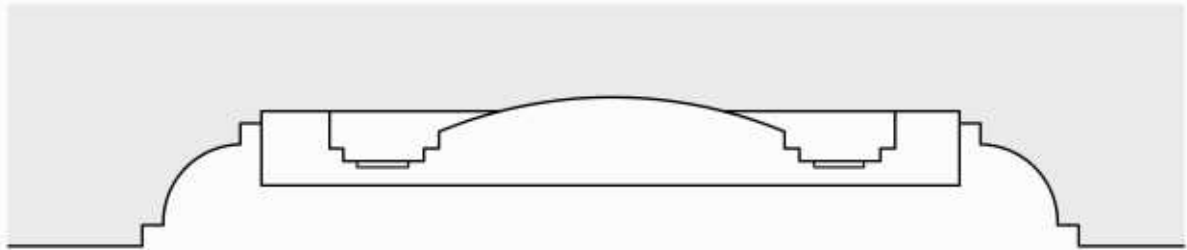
Ipotesi AA', con il piano di fondo concavo.
